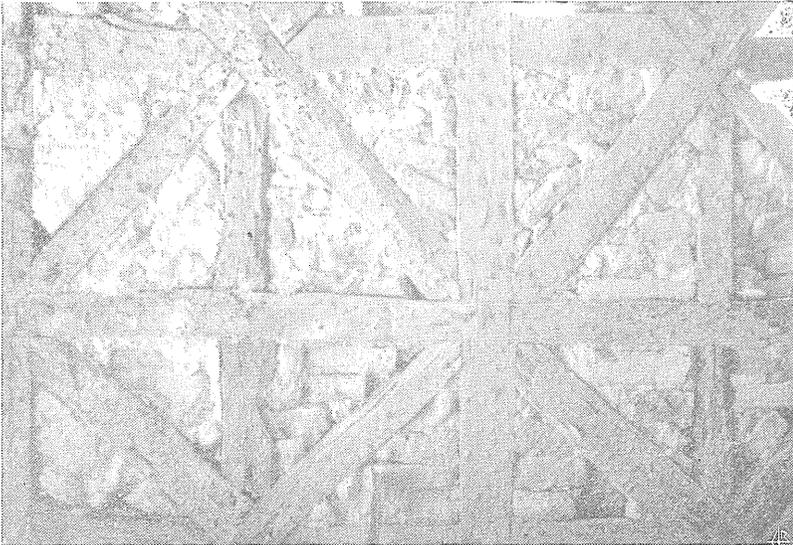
Porto — Bairro da Sé. Pormenor.
